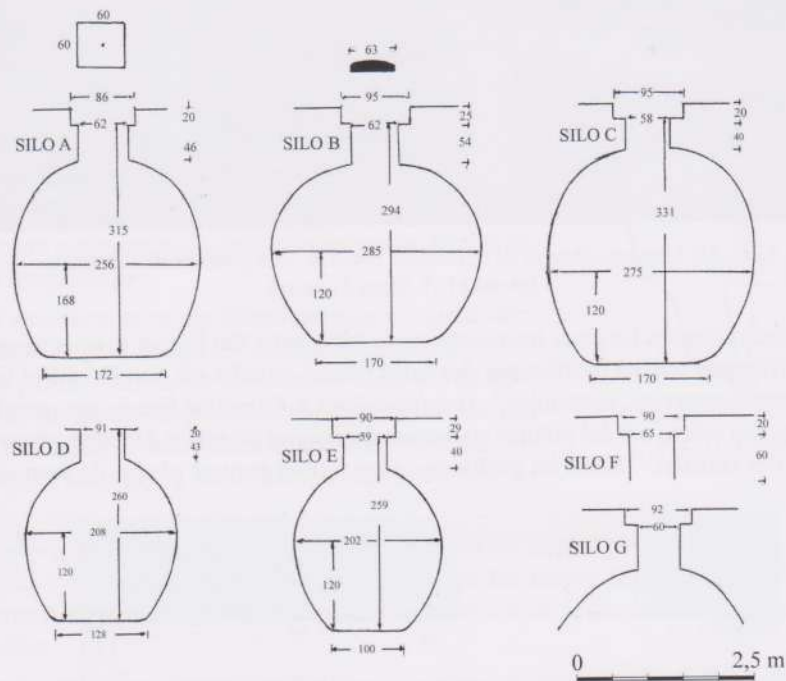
Gimont. Abbaye de Planselve. Porterie. Dimensions des silos (relevés J. Lajoux et H. Monlezun, Groupe archéo de Gimont)
